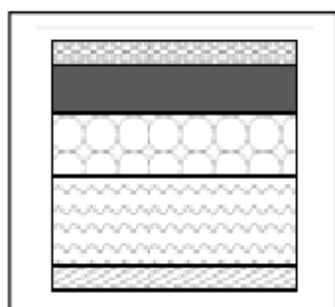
Chaussées à assise traitée aux liants hydrauliques.(Nguyen, 2008)
